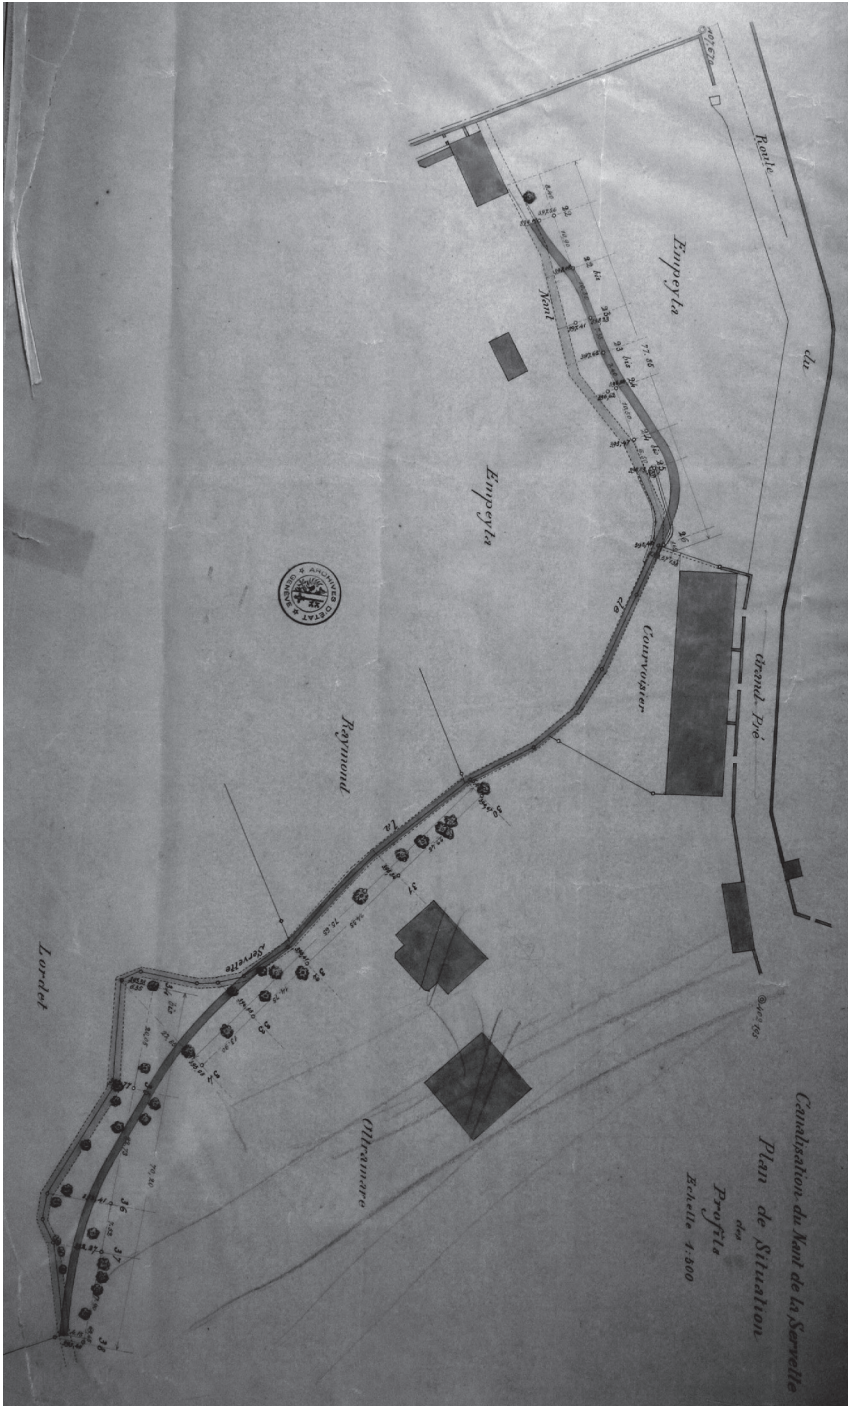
Plan partiel du tracé de l'égout collecteur de la rive droite.
